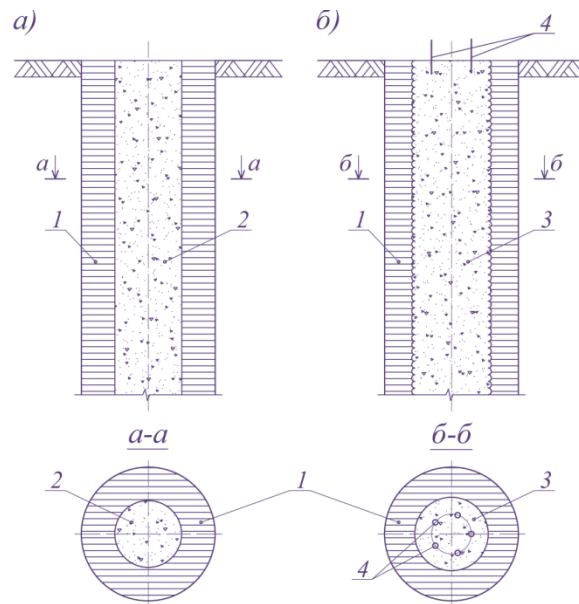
Схема устройства грунтобетонной сваи (ГБС)
